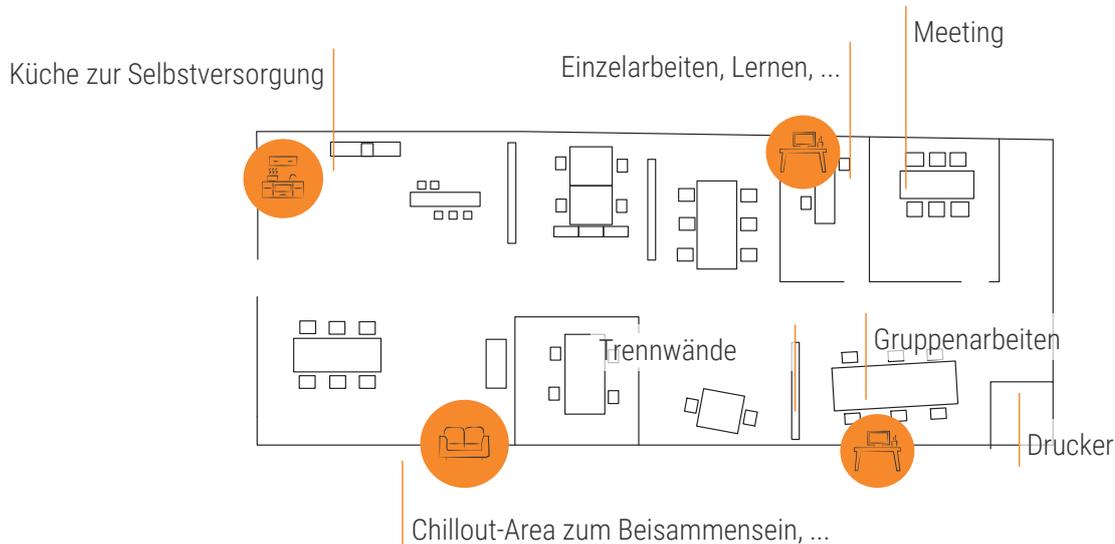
Exemplarischer Grundriss, schematische Darstellung (o. M.)
